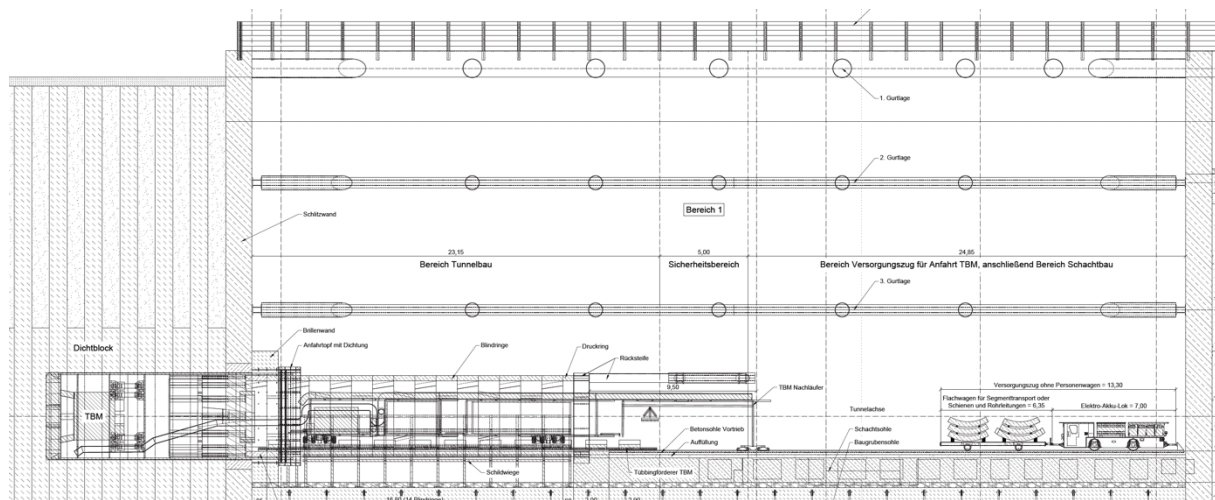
Darstellung Phase Tunnelanfahrt in Startbaugrube (Ausschnitt aus Teil F1.1.3.11)
